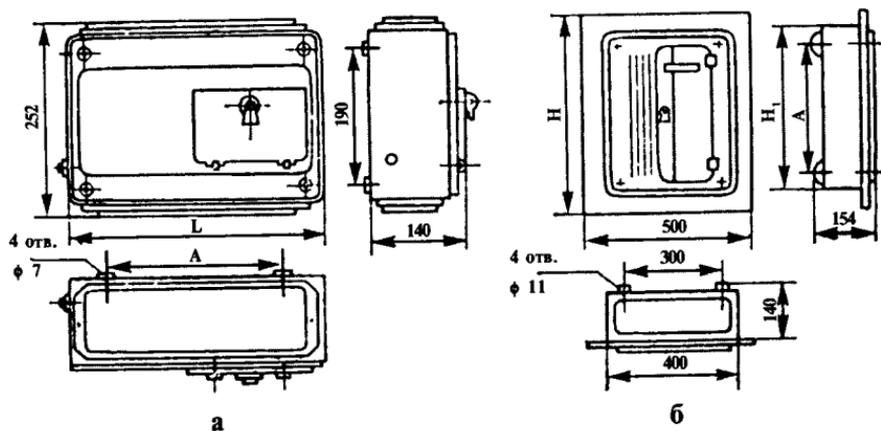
Щитки для промышленных зданий, устанавливаемые на стене (а) и в нише (б)
